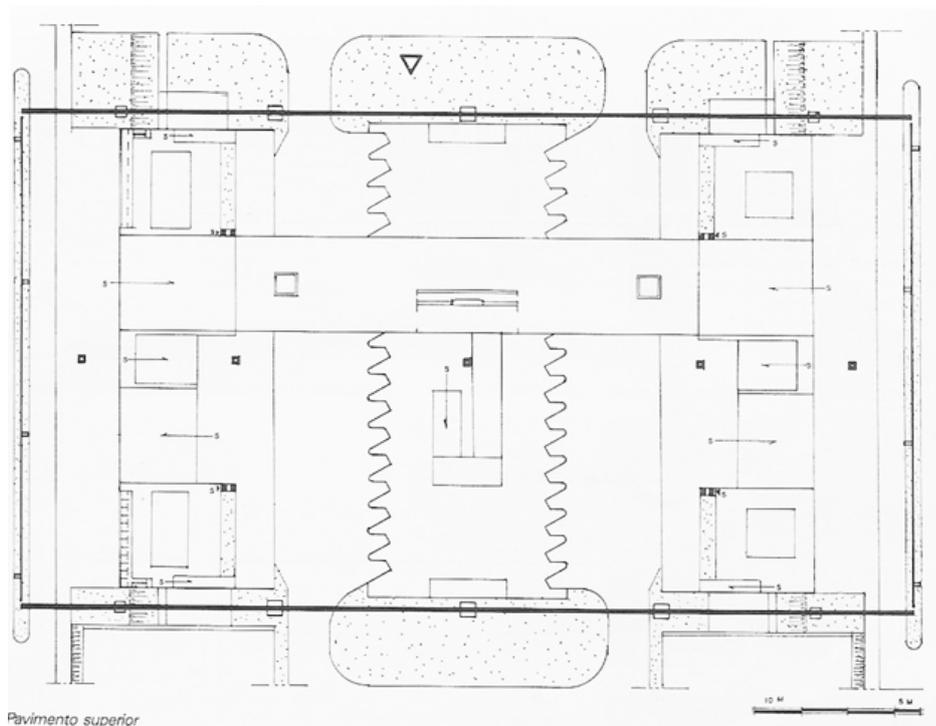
Planta Baixa do Pavimento Superior - Portal Goiânia
